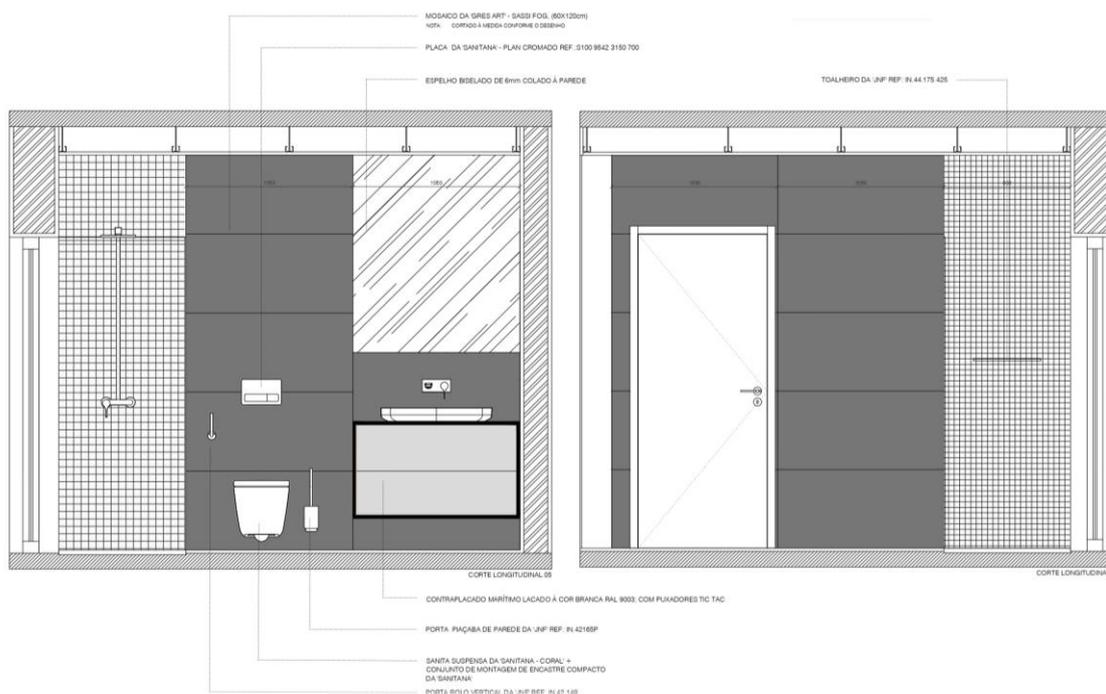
Corte longitudinal da instalação sanitária 06B.
